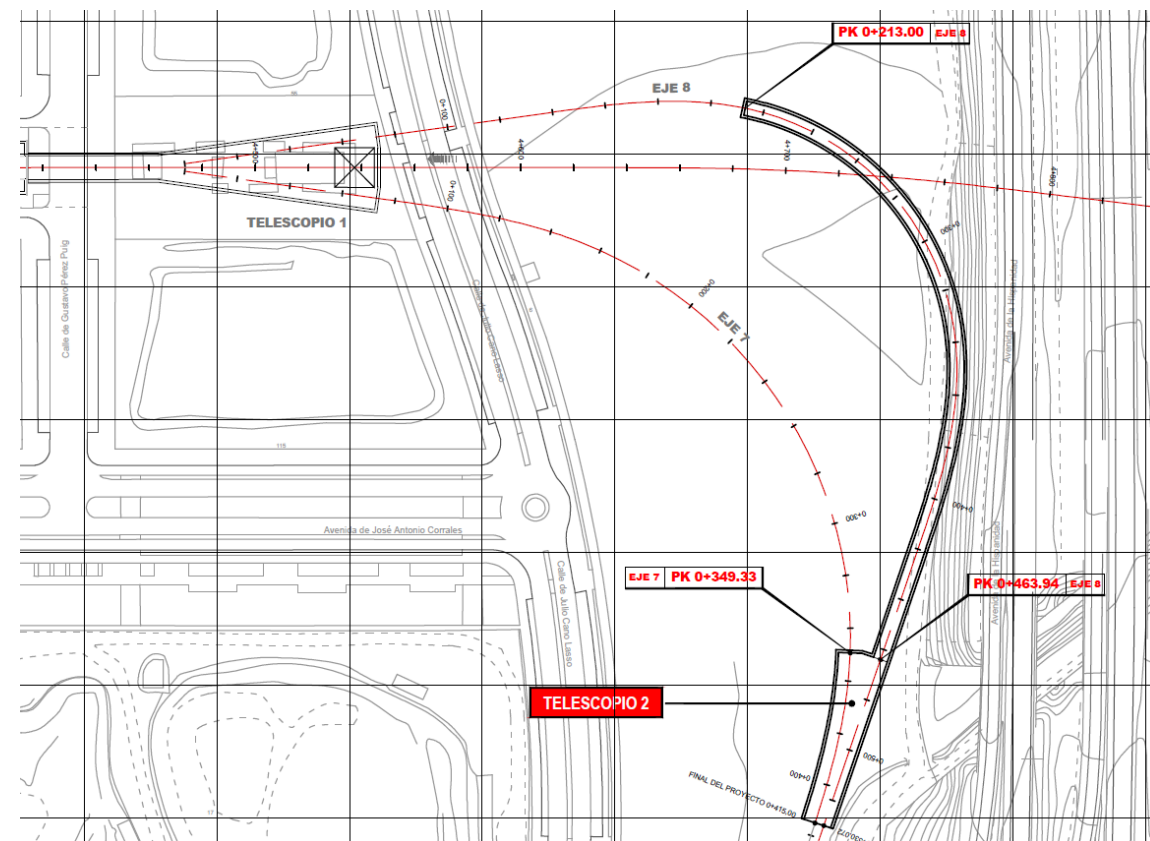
Vista en planta de la ubicación de Telescopio 1 y Telescopio 2 y ramales
